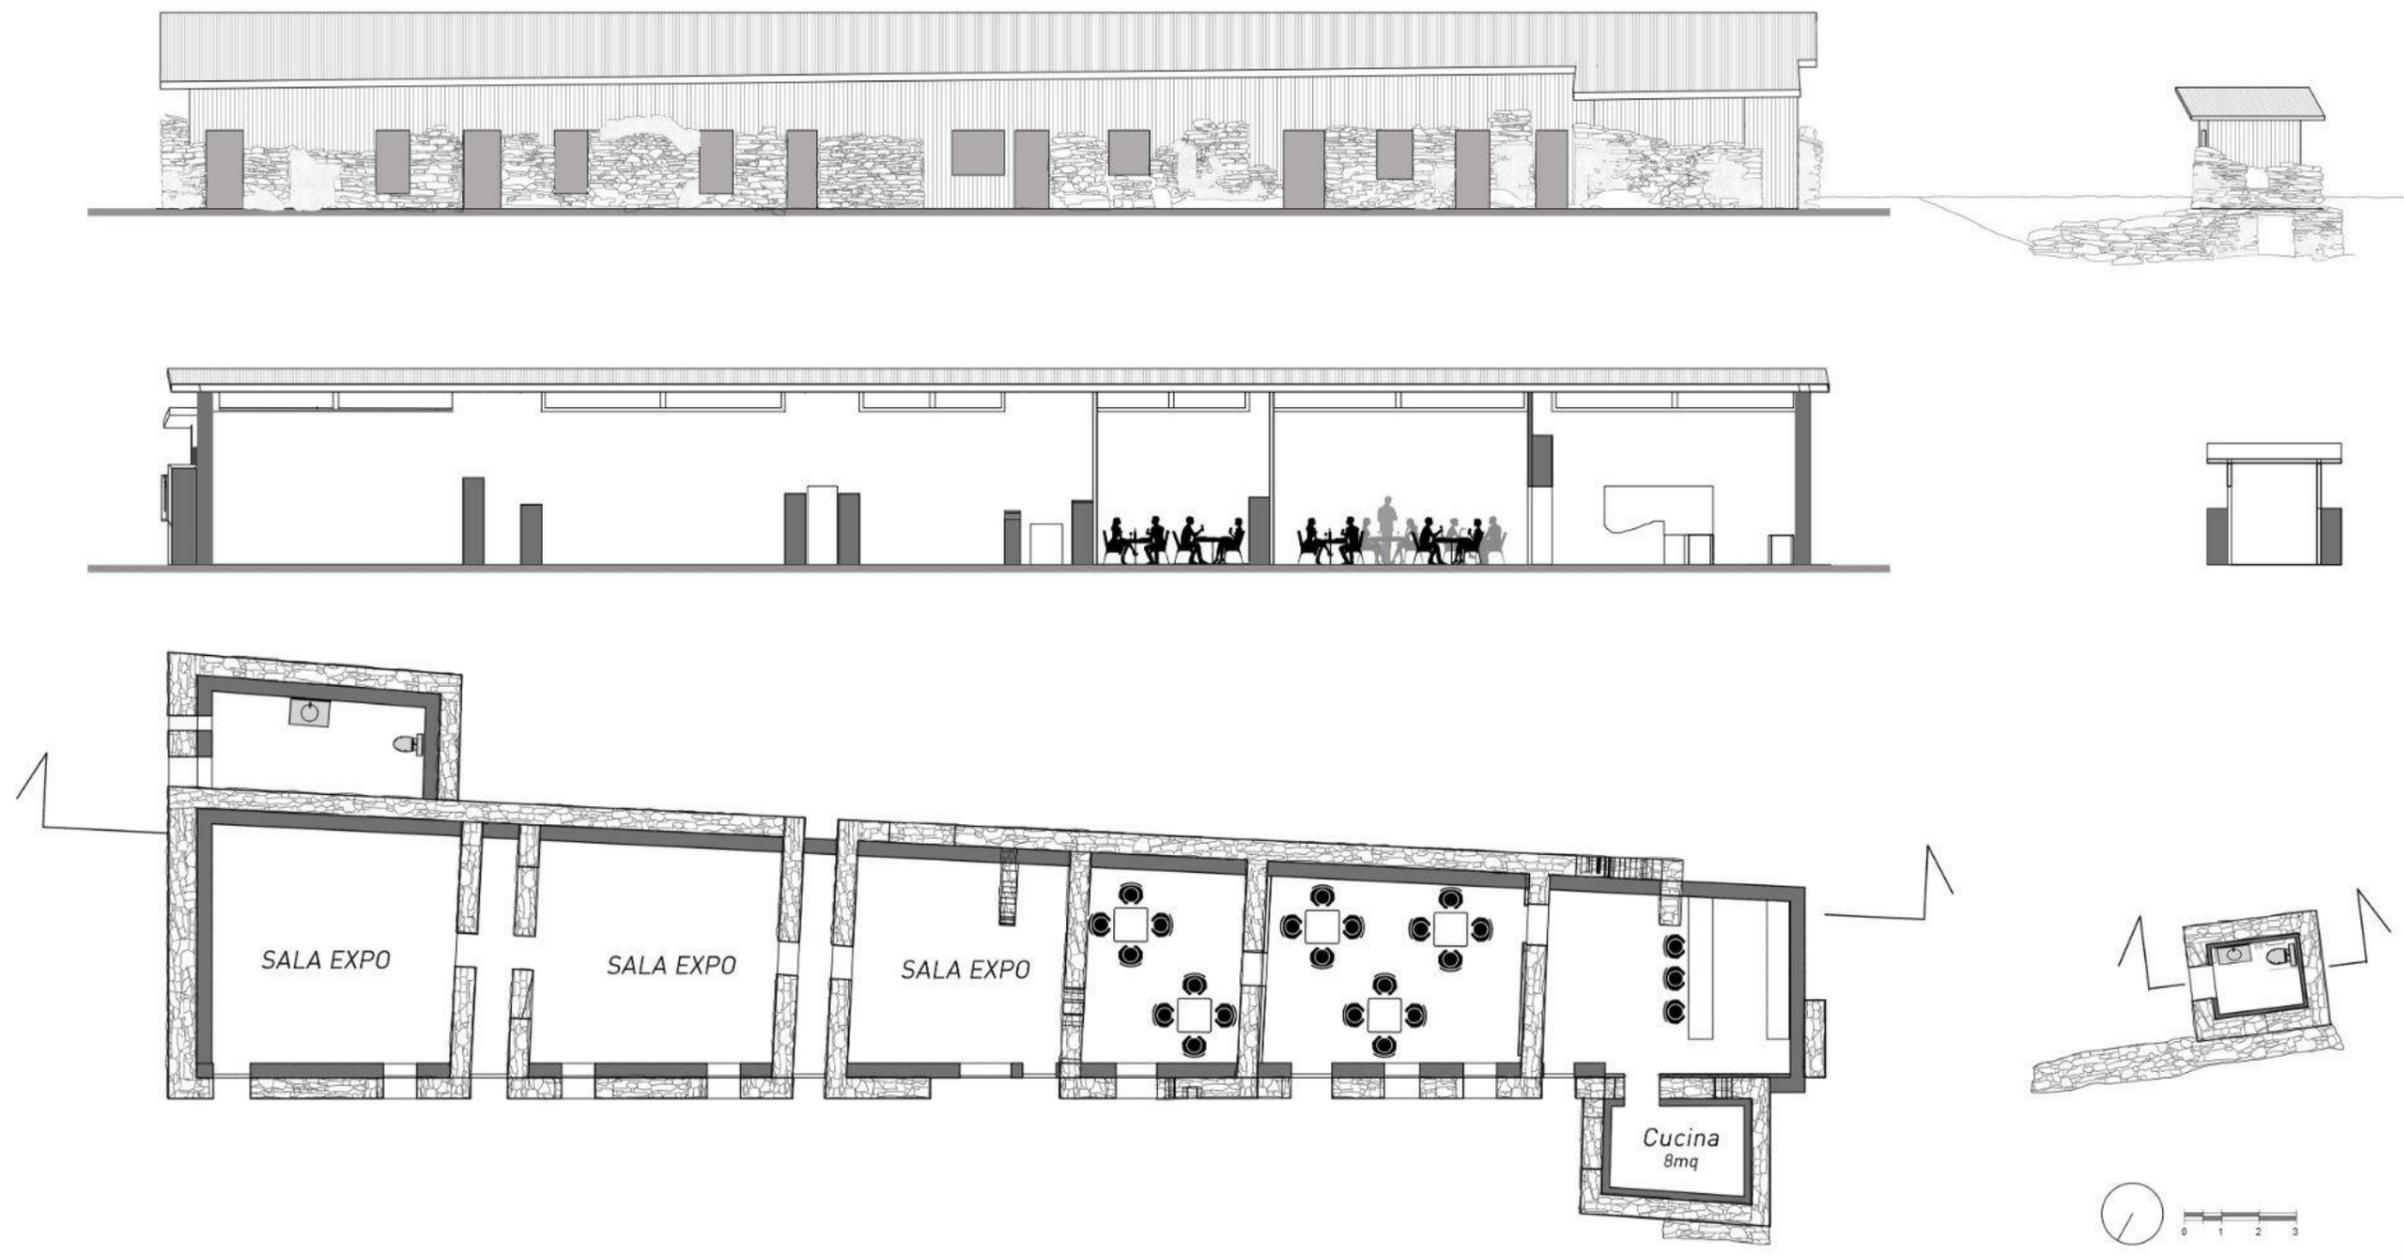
Andriani Mario. dall'alto Prospetto, sezione e planimetria di progetto
